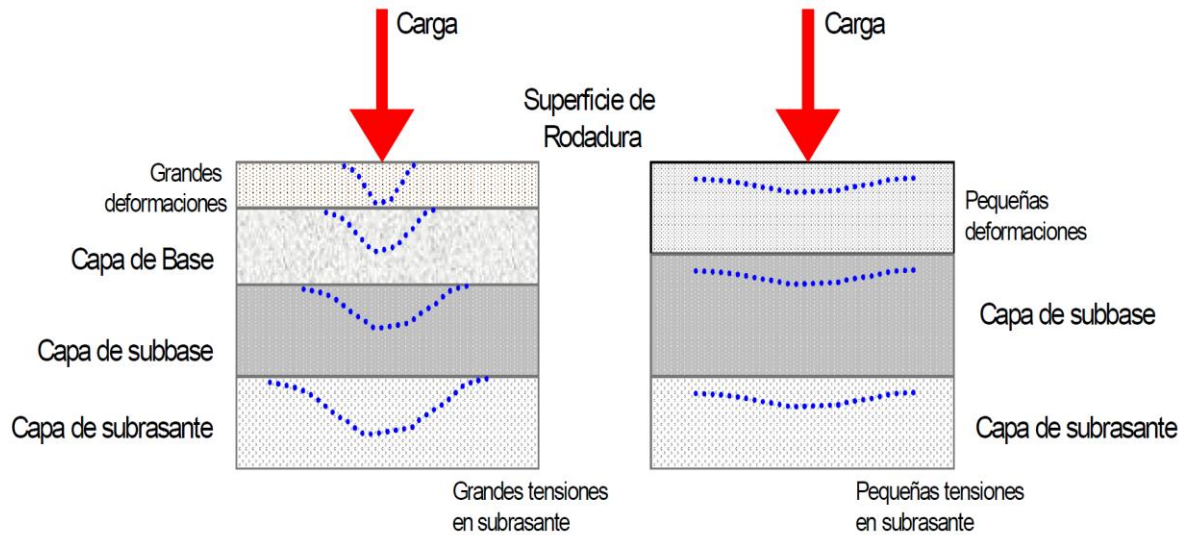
Comportamiento de pavimentos rígidos y flexibles
